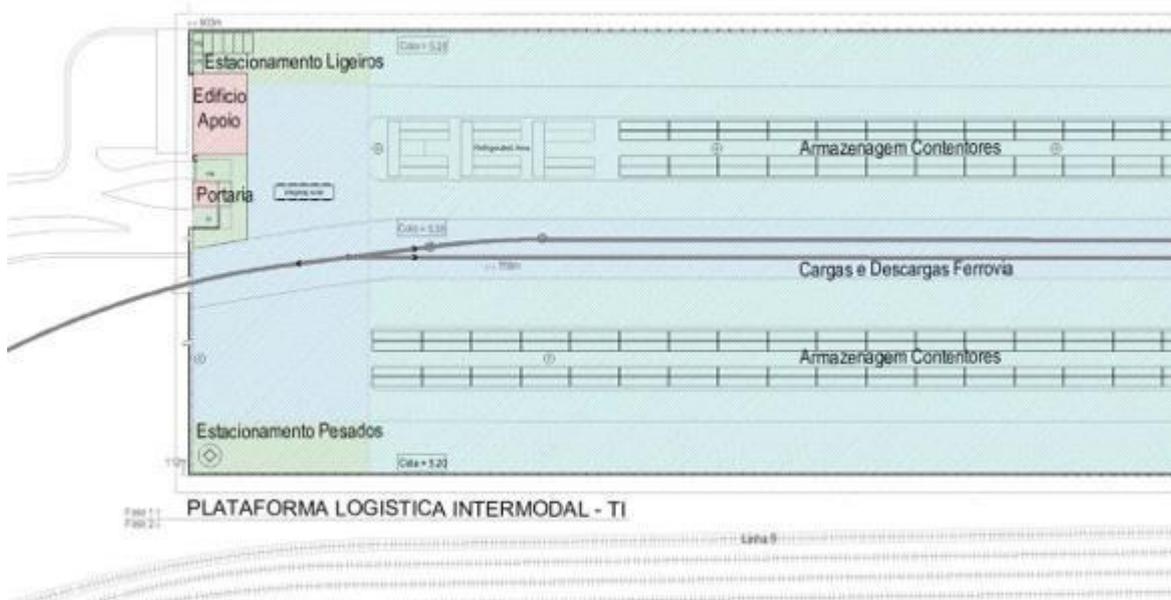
Layout de implantação da plataforma do intermodal, entrada sudoeste. (Fonte: EIA, 2024)
